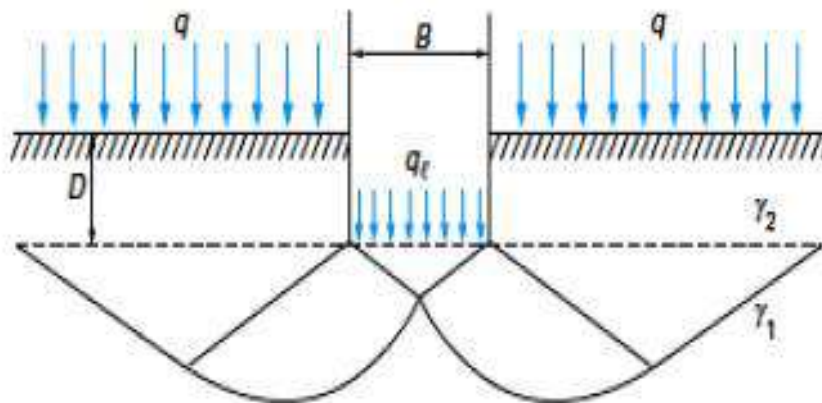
3 Schéma de rupture d'une fondation superficielle
